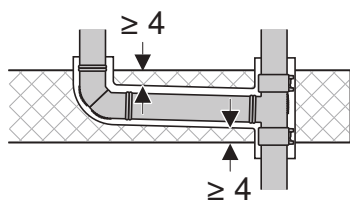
Betongövertäckning vid betongingjutna anslutningsledningar
